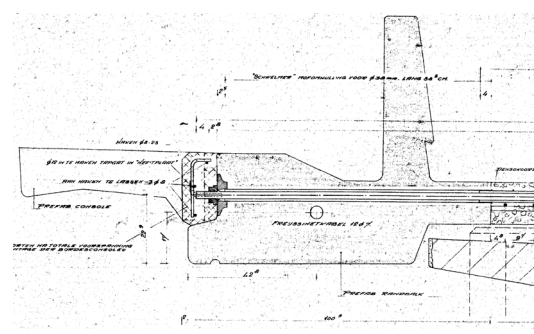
Detail moerbevestiging prefab console (fragment uit HIC903~1.TIF)
